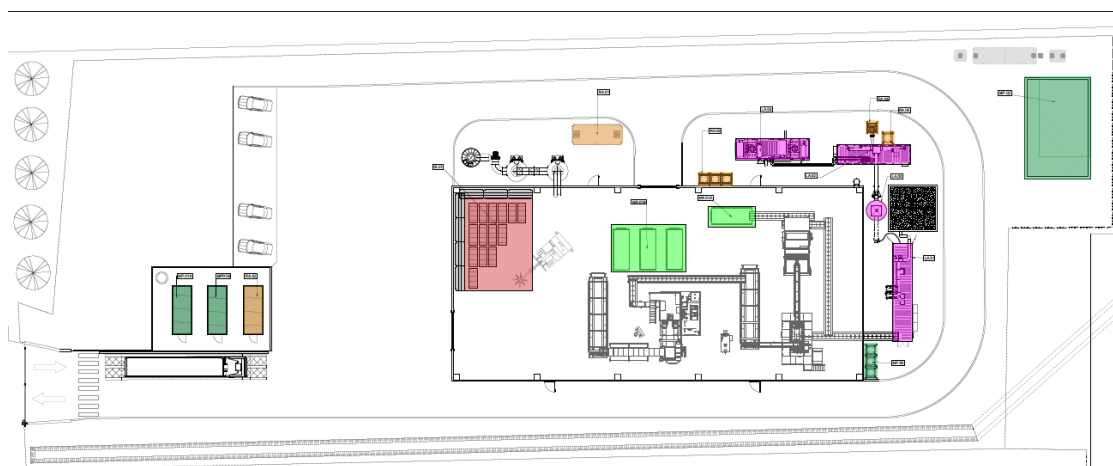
PFTE_EGR_PRO_003 – Planimetria aree lavorazione e materie prime
